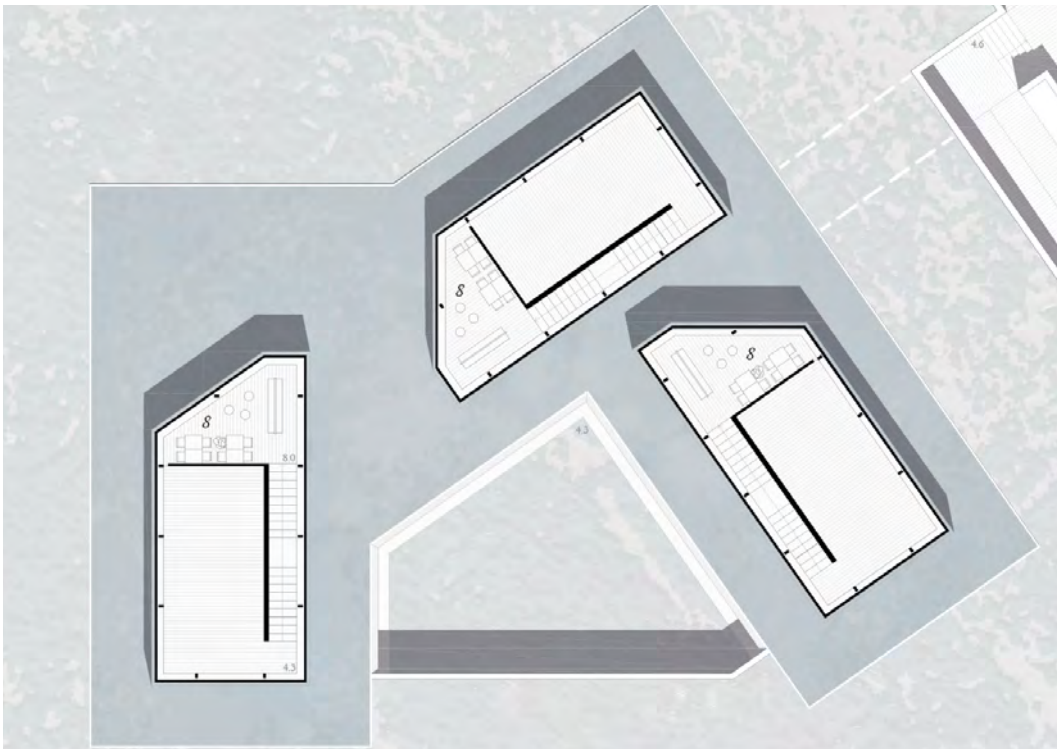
Planta do piso 1 do Laboratório de Interpretação (Salas de Leitura)
